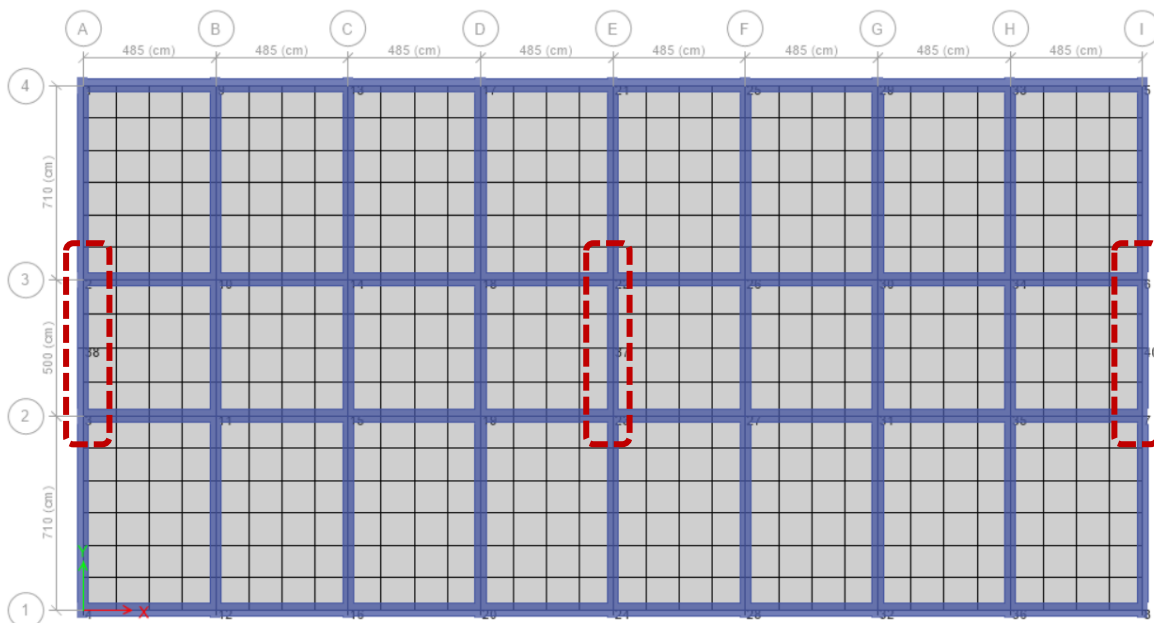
Ubicación en planta de contravientos COREBRACE sentido y
